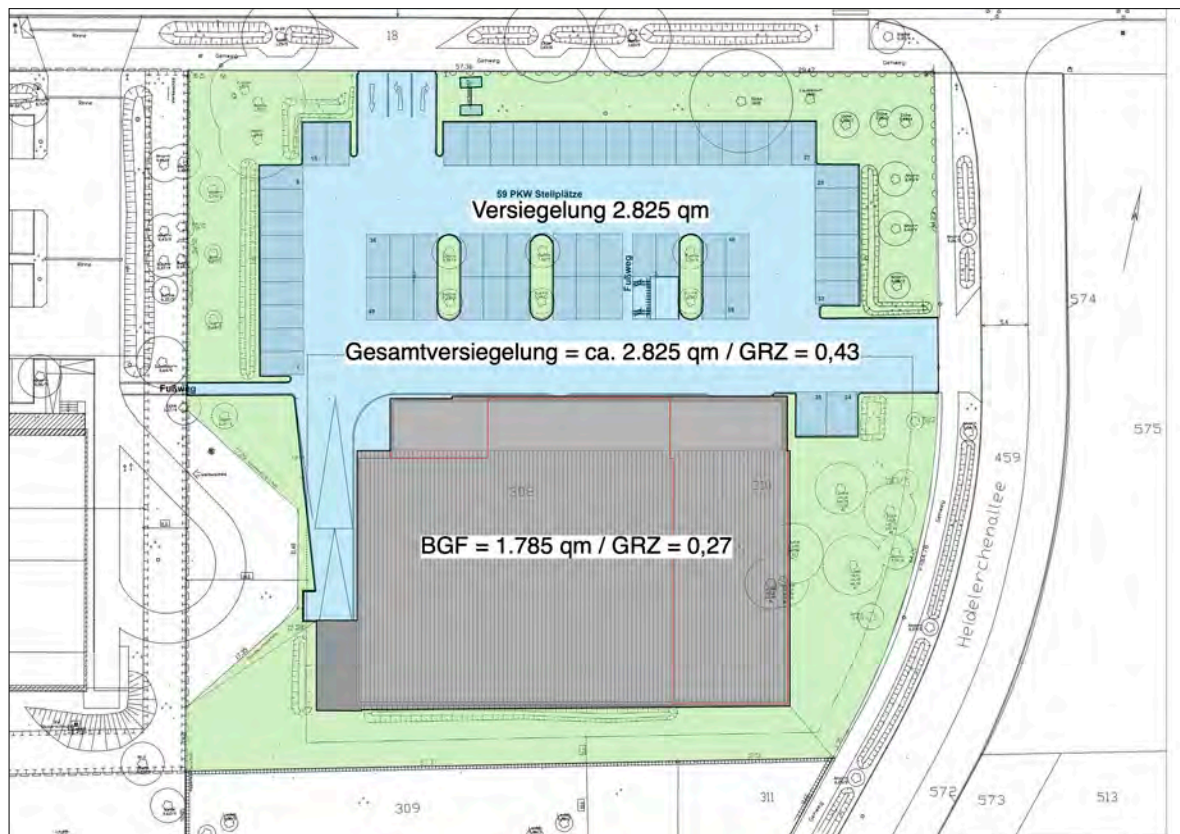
Lageplan Nahversorgungsmarkt (Quelle: Architekturbüro Krauter+Kling, Berlin)
